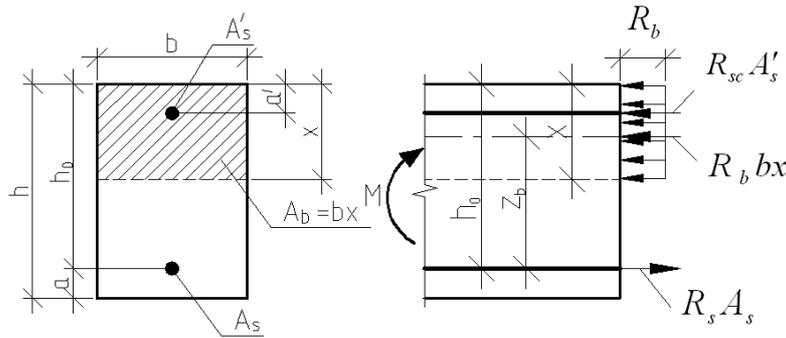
Прямоугольное сечение с двойной арматурой и схема усилий
